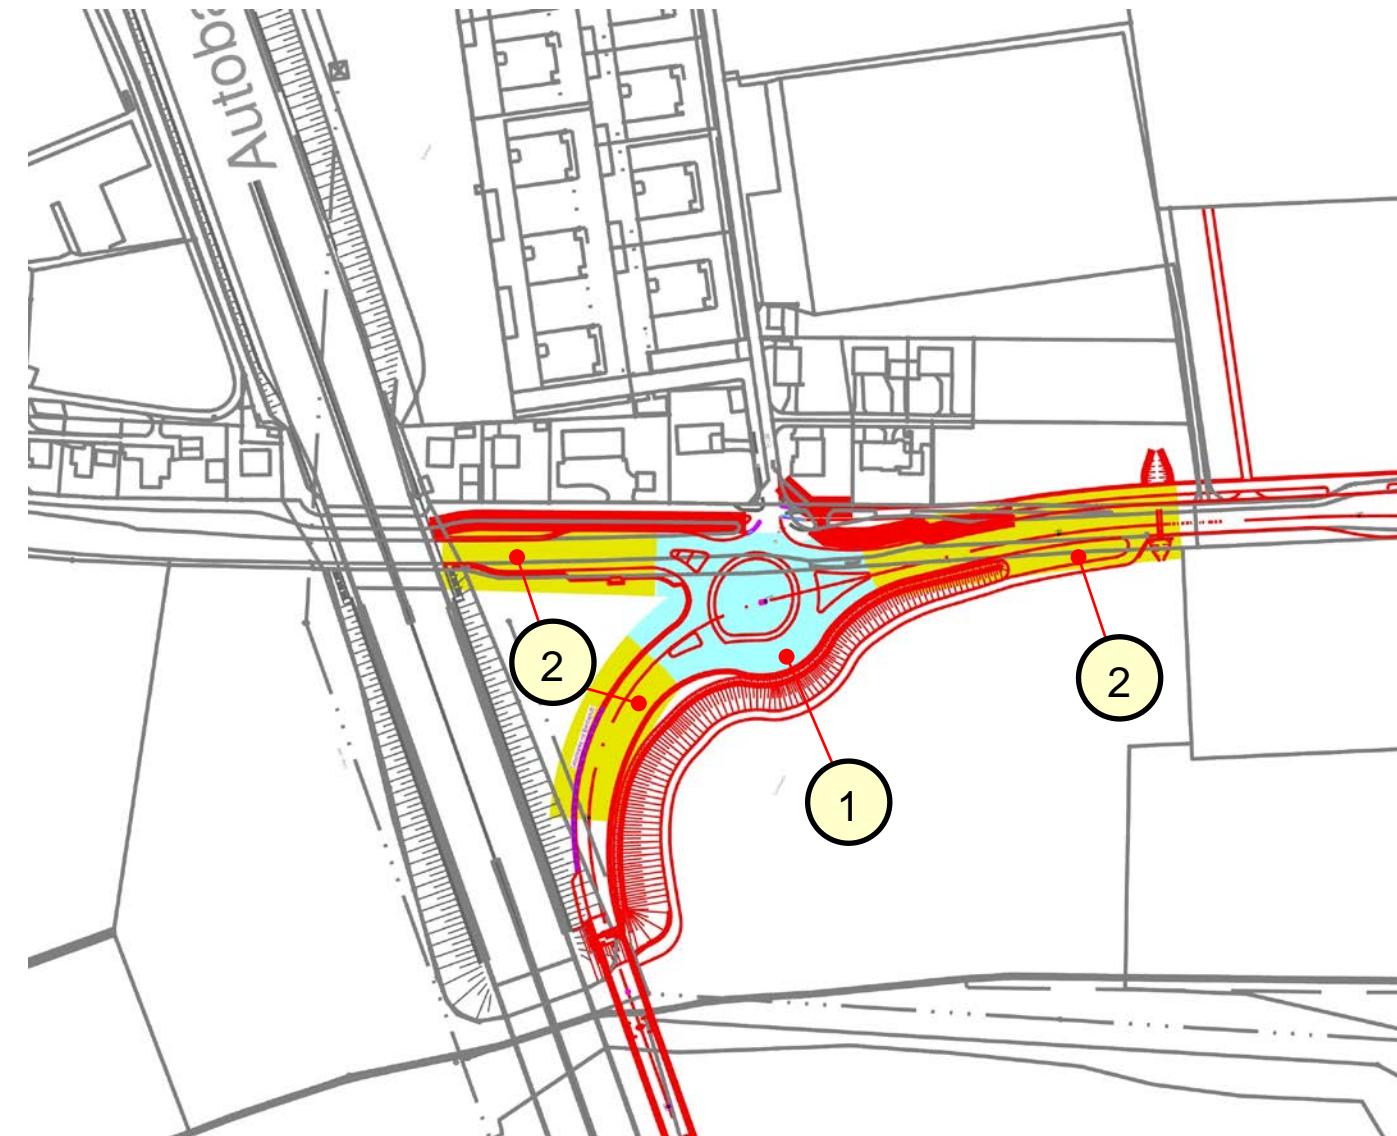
Straßenprojekt mit Lärmassnahmen
